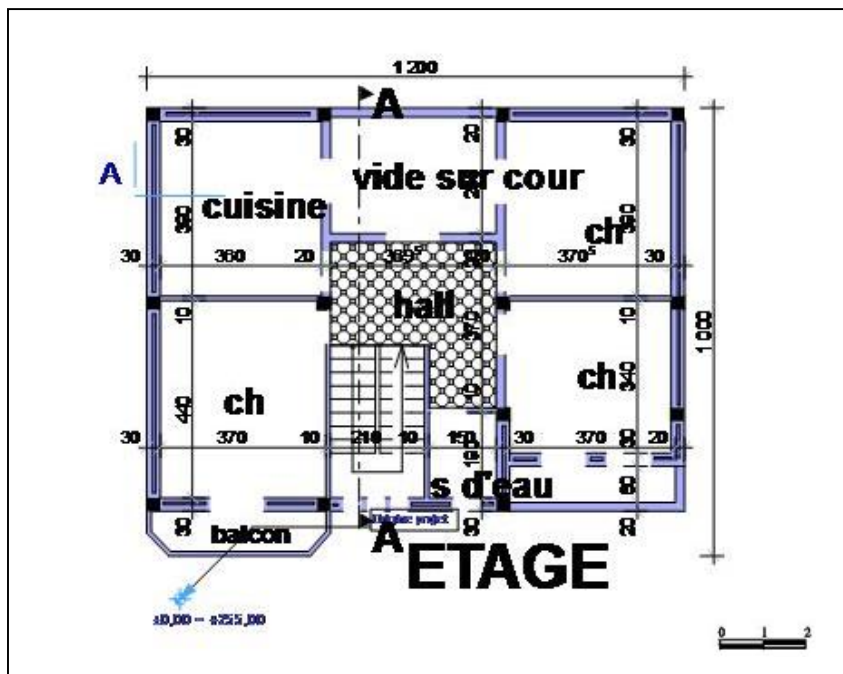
, échantillon 06, plan ETAGE d'une habitation individuelle, prise comme plan type d'une maison a niveau de revenus moyens, lotissement ENNAHDA
